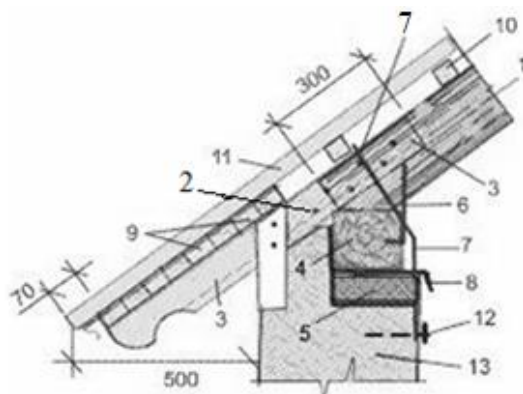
Схемы поперечных и продольных разрезов двускатных наслонных стропильных систем
